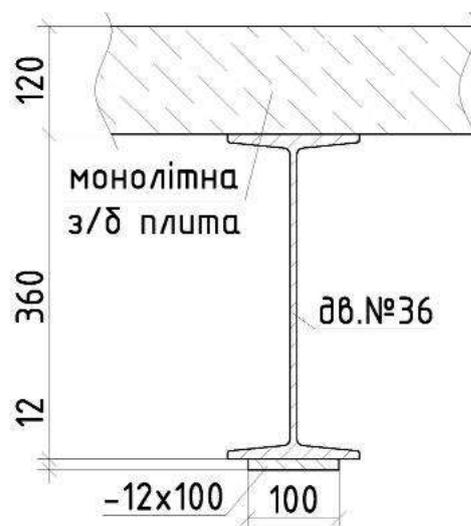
Поперечний переріз вбудованого СЗБ перекриття
